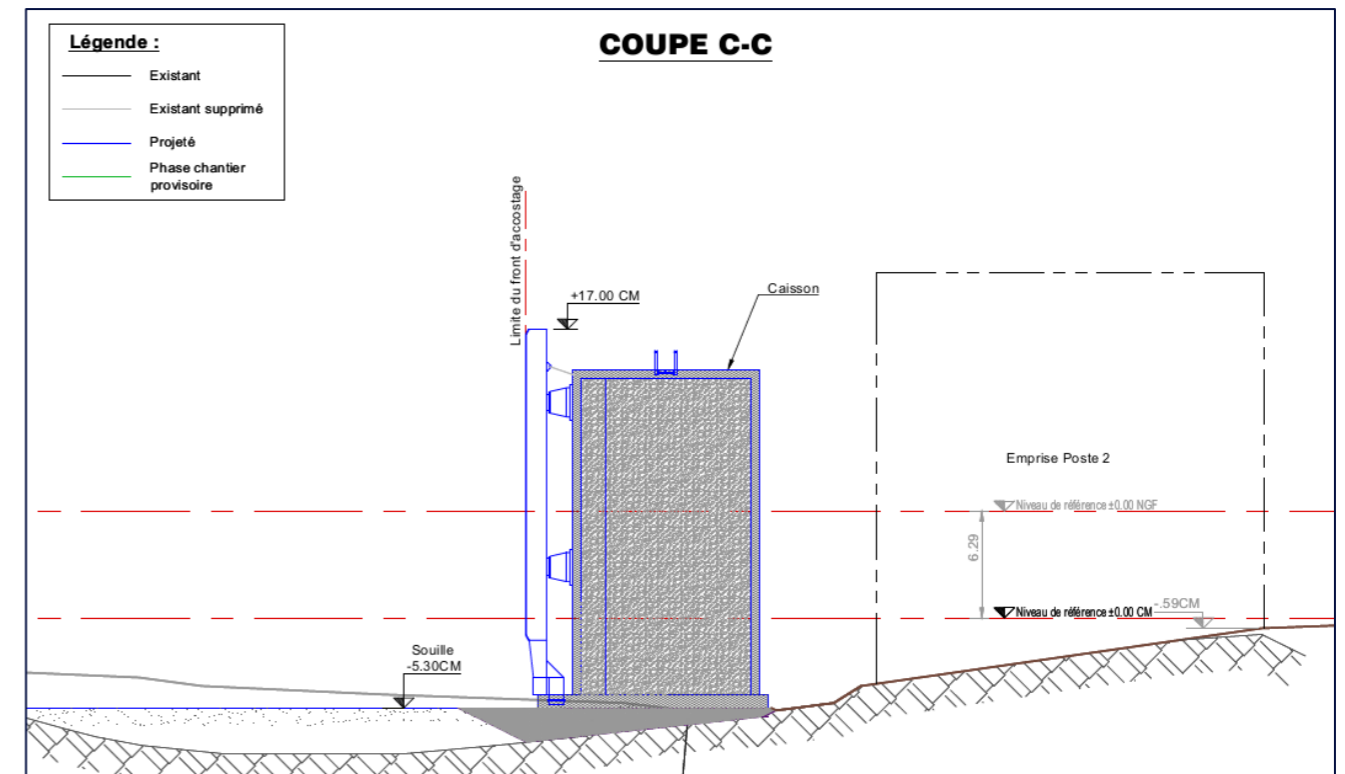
Coupe type d'un caisson de Duc d'albe d'accostage (zone 1 du poste 1)
